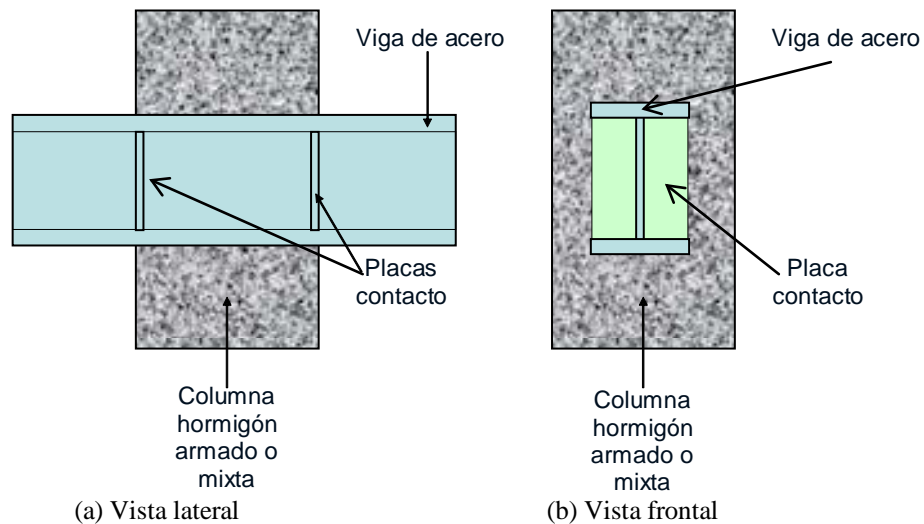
Conexión viga de acero a columna de hormigón armado o columna de acero embebida en hormigón
